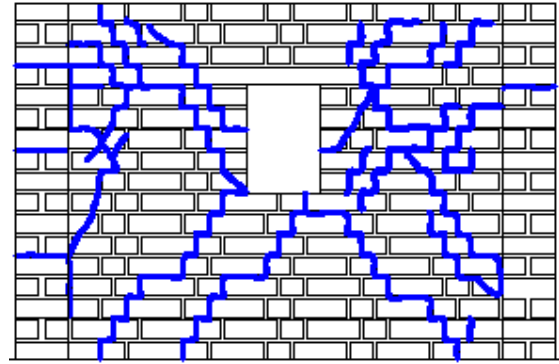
Levantamiento de fisuras del muro sin refuerzo (Madueño I.)
